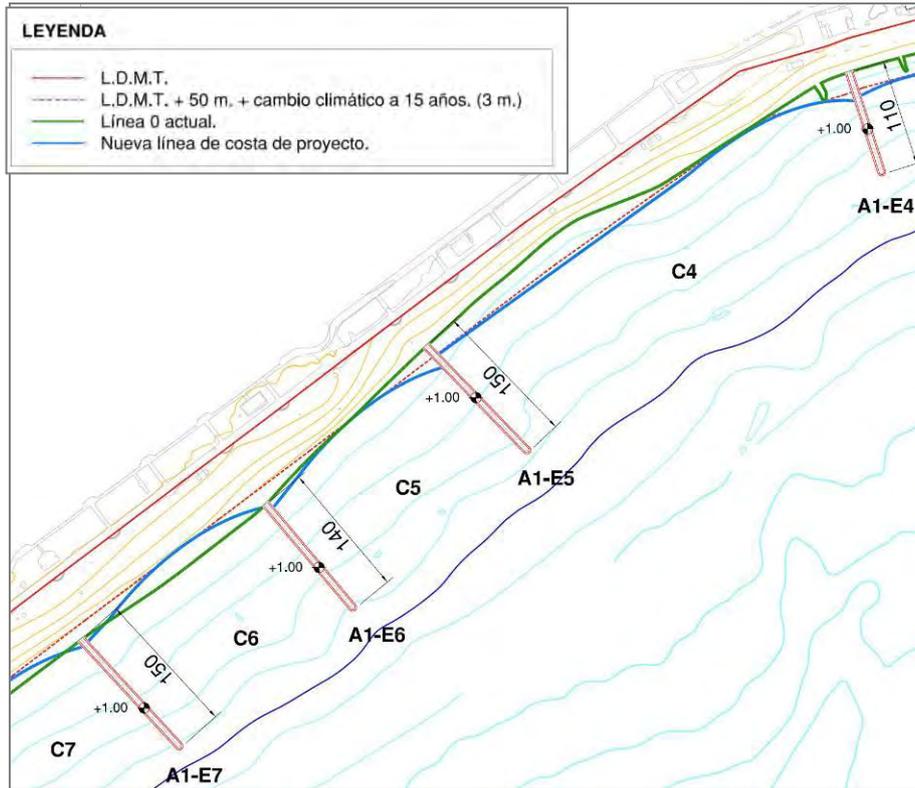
Planta Alternativa 1. Celdas C4-C6.
